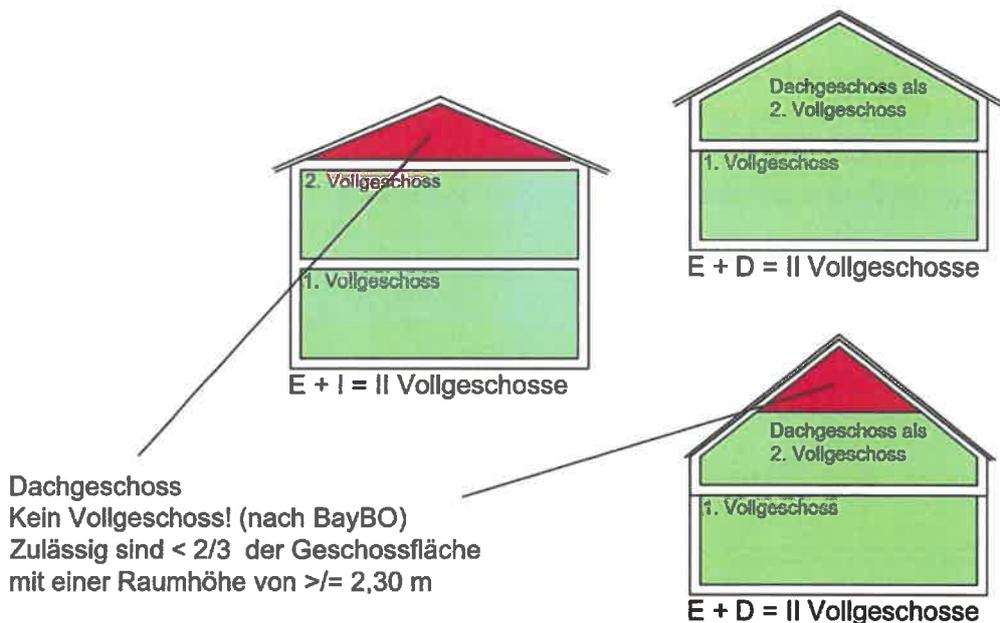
Erläuterung Vollgeschosse, mögliche Bauformen
